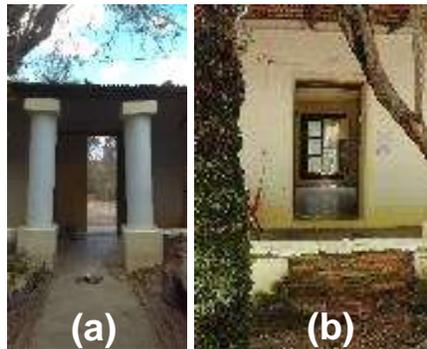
(a) Columna que ha perdido la verticalidad. (b) murete de ladrillo con desprendimiento.
